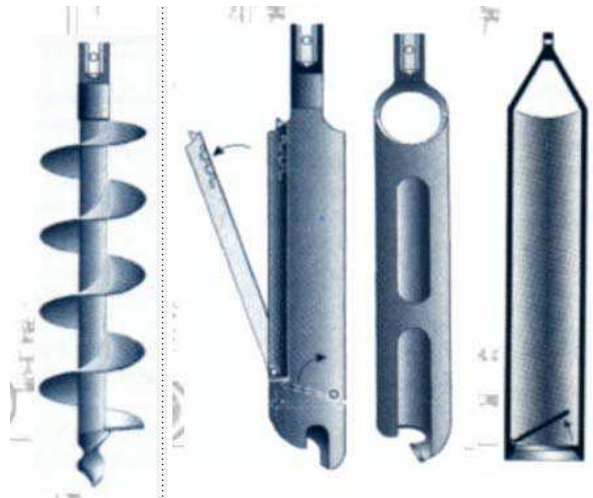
Spiralbohrer – Schappe - Ventilbohrer
